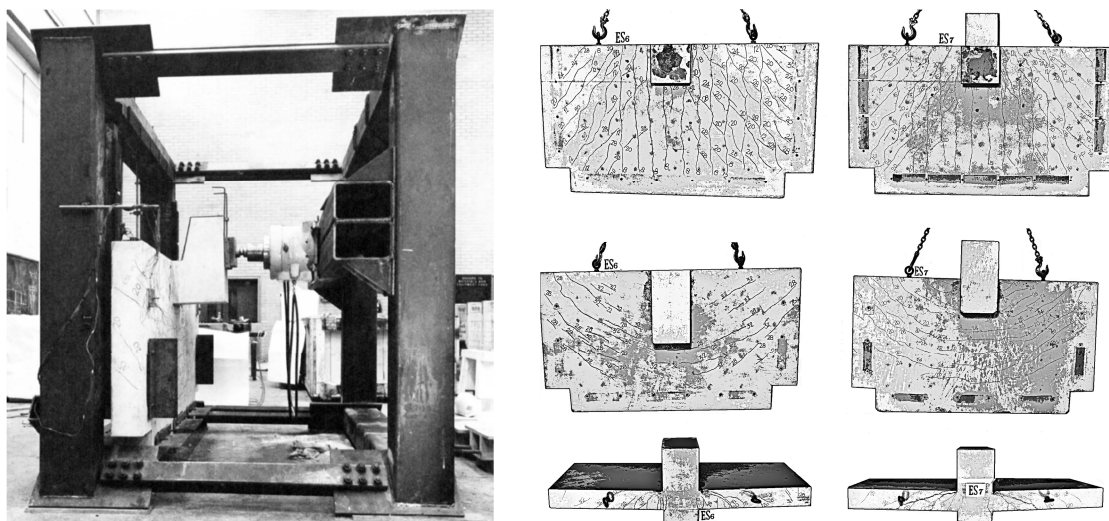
Arranjo de ensaio e lajes ensaiadas por NARASIMHAN (1971)
